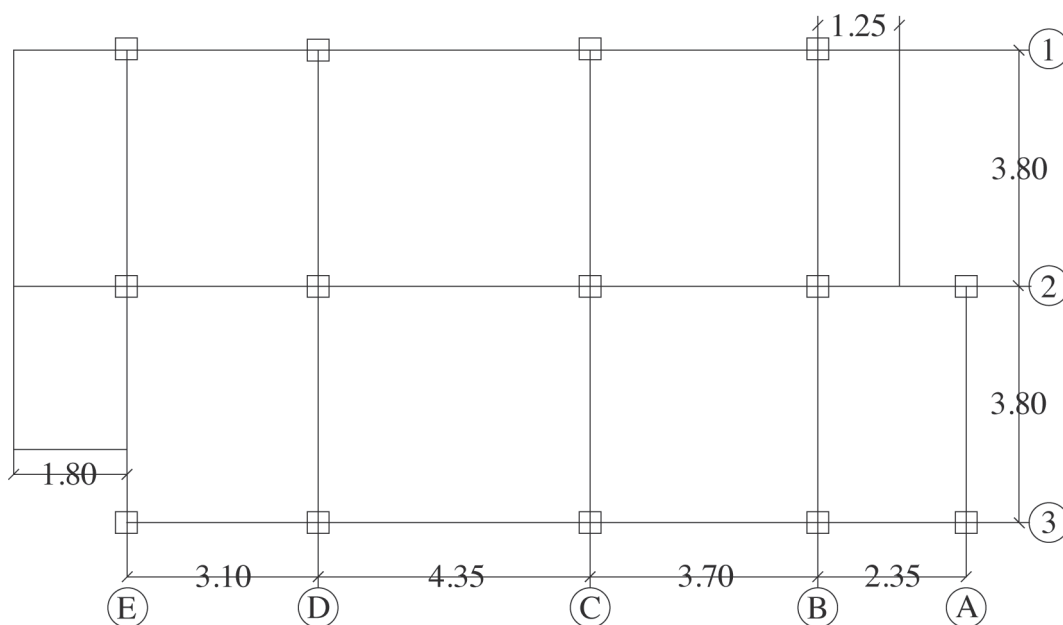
Vista de planta de las columnas y ejes estructurales del edificio estudiado.
